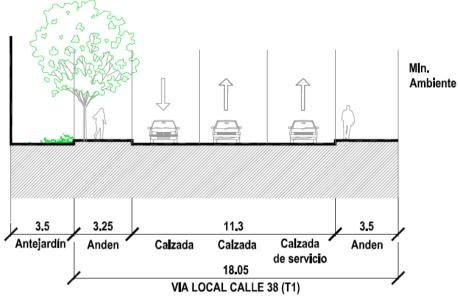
Perfil propuesto Calle 38 B Tipo V-7.
